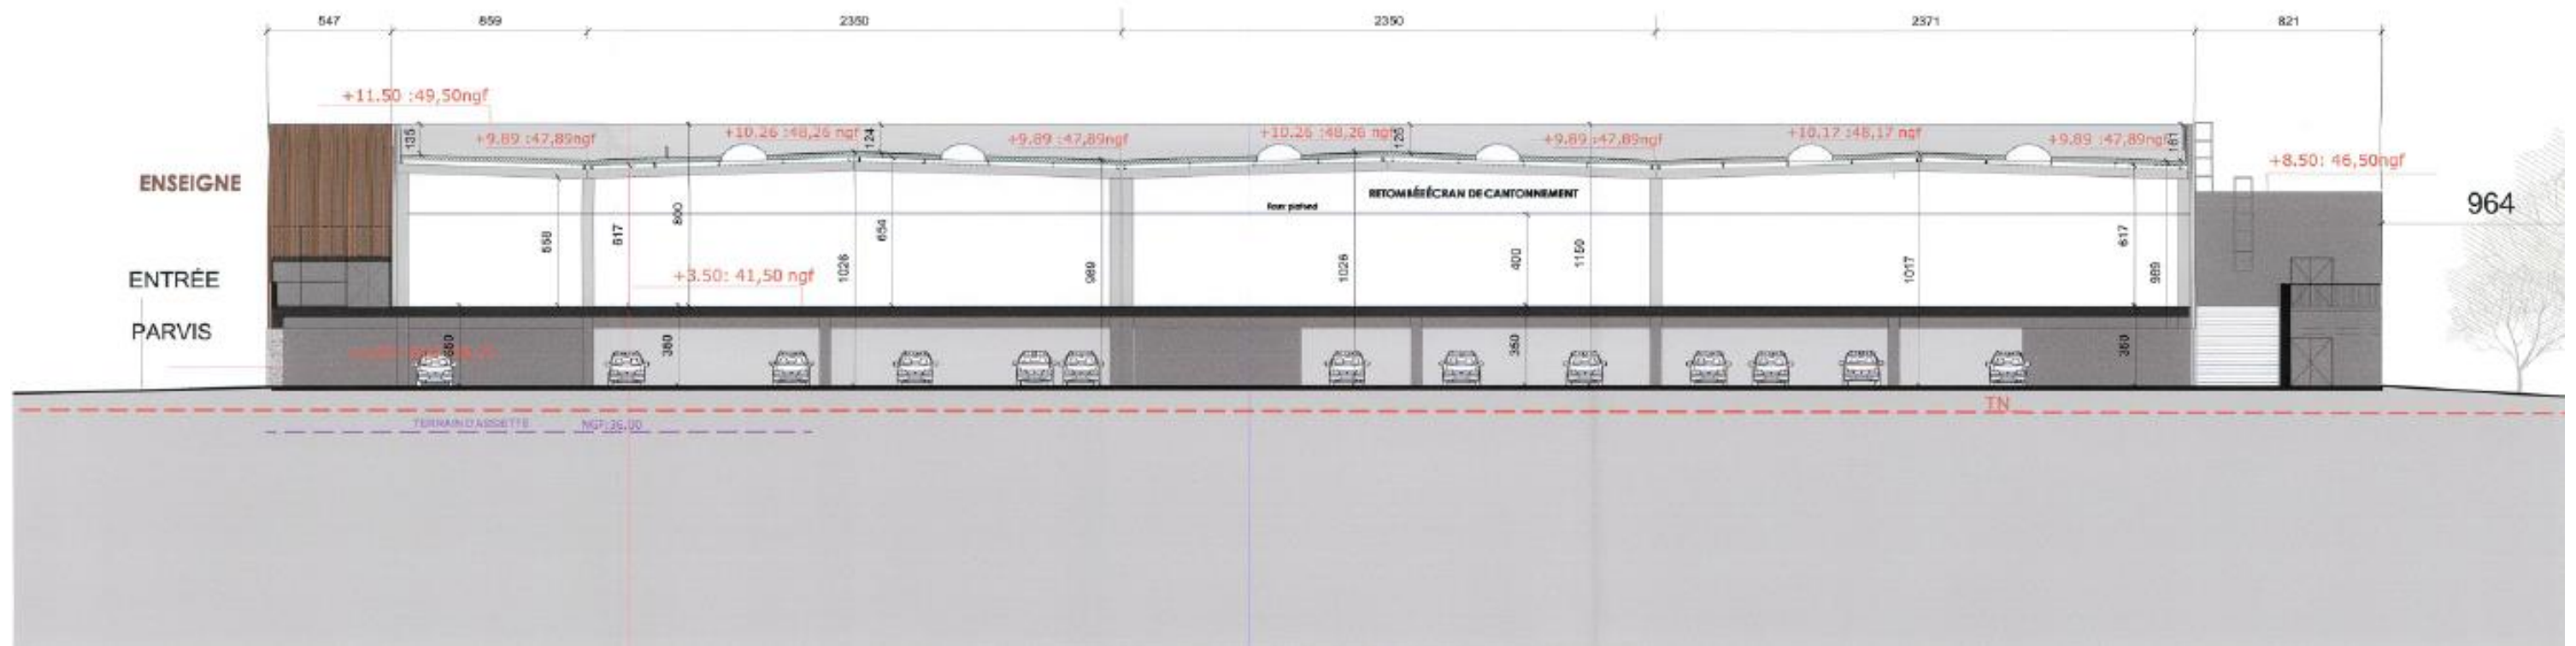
Coupe sur bâtiment – Avenue Jean Monnet – A9
